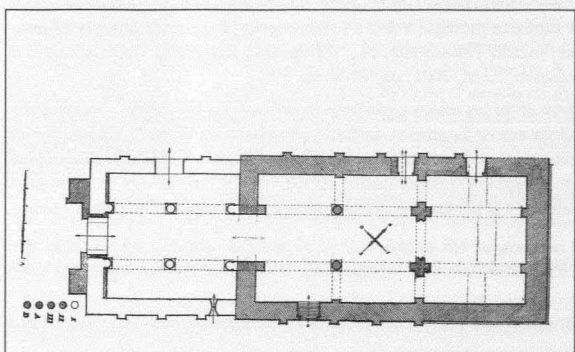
Planta de San Pedro de Teverga (según H. Schlunck y J. Manzanares).
